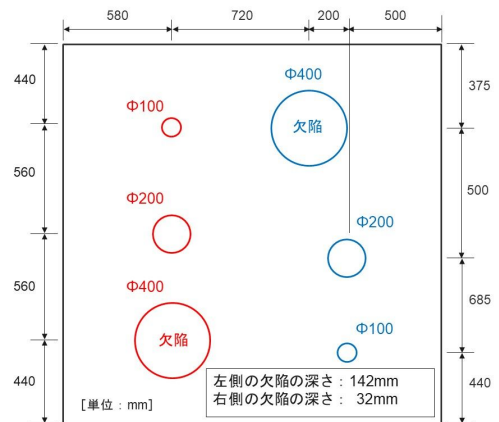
コンクリート供試体および人工欠陥の配置状況
